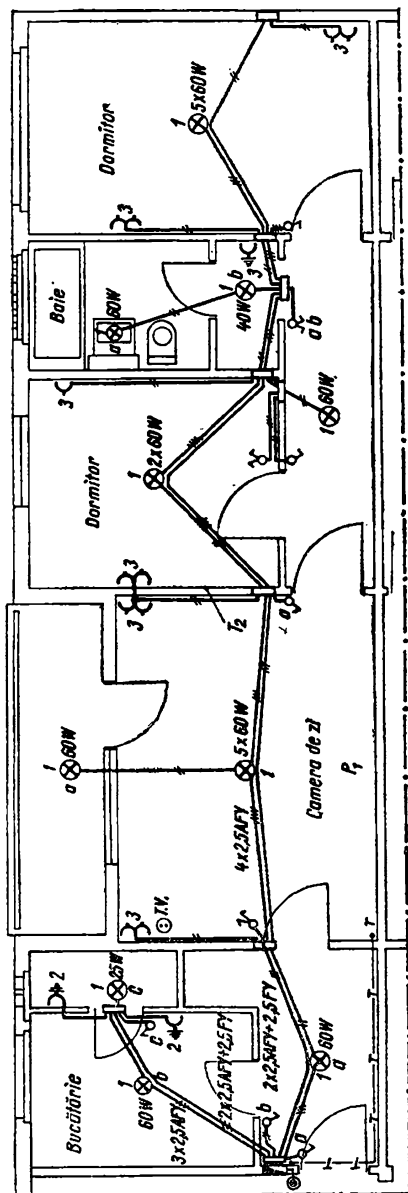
Planul unei instalații electrice cu circuite montate în goluri (canale) lăsate în panourile de beton armat (sistem canalex):
